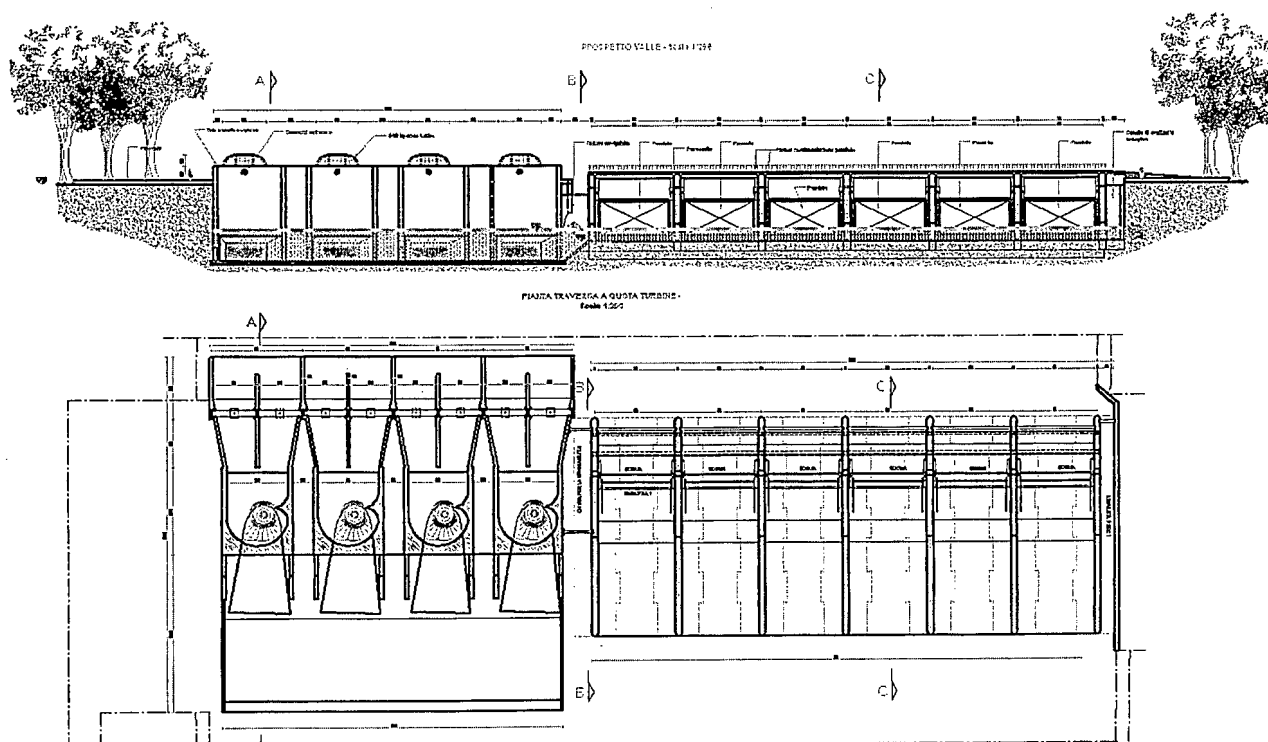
Variante progettuale: prospetto di valle e planimetria a quota turbine della centrale idroelettrica
